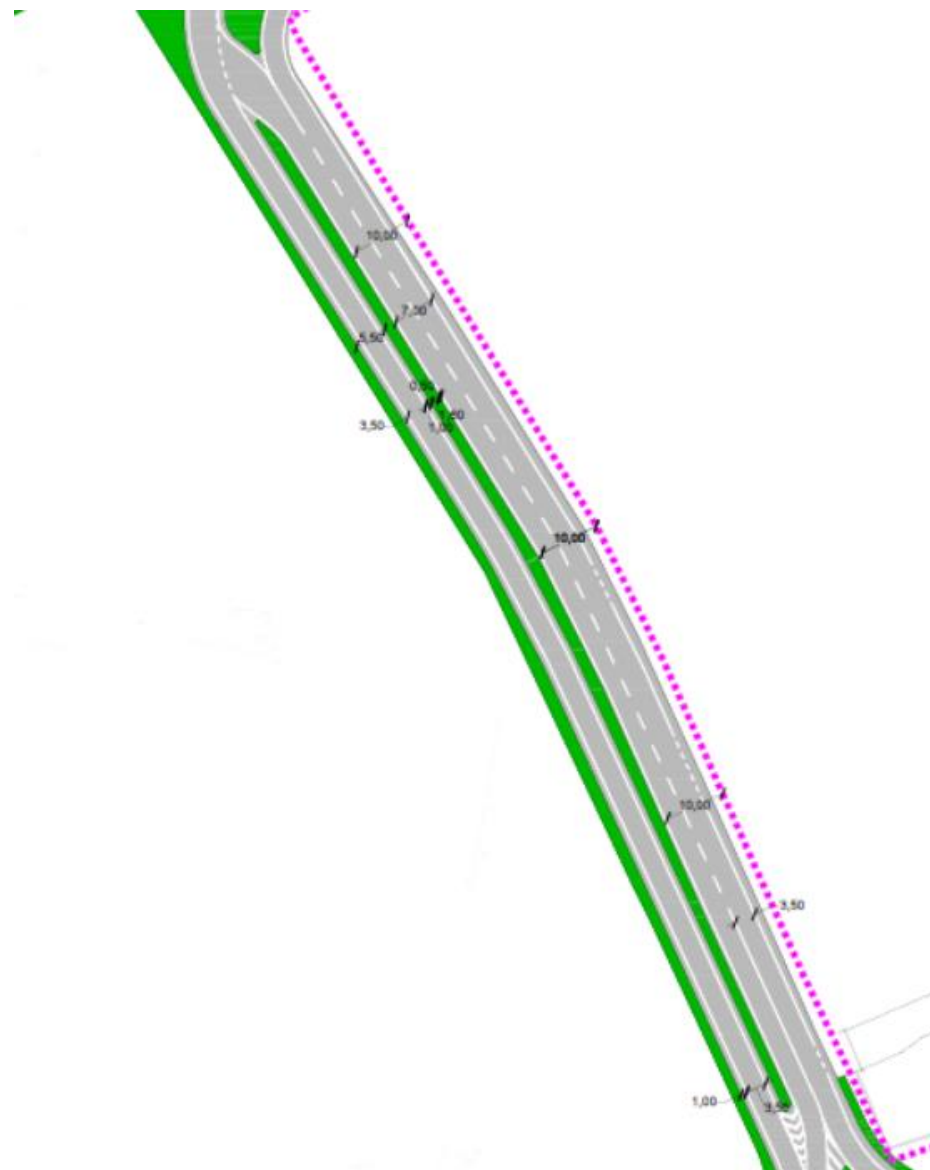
Contro-strada lungo via Franceschini – Ipotesi 1 – Planimetria di progetto
